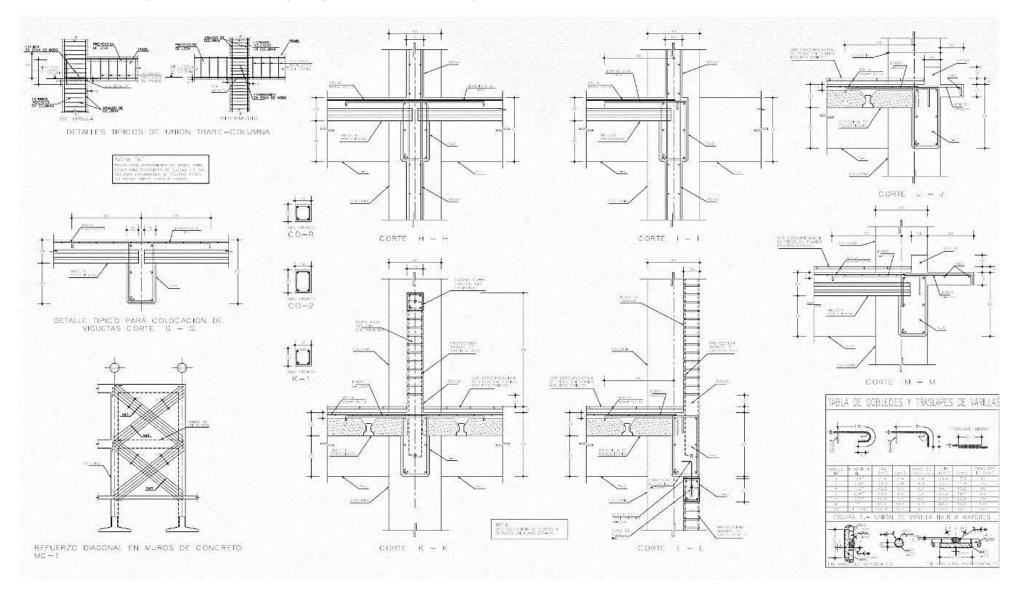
Cortes estructurales (Dependiendo del tipo del tipo de estructura)
